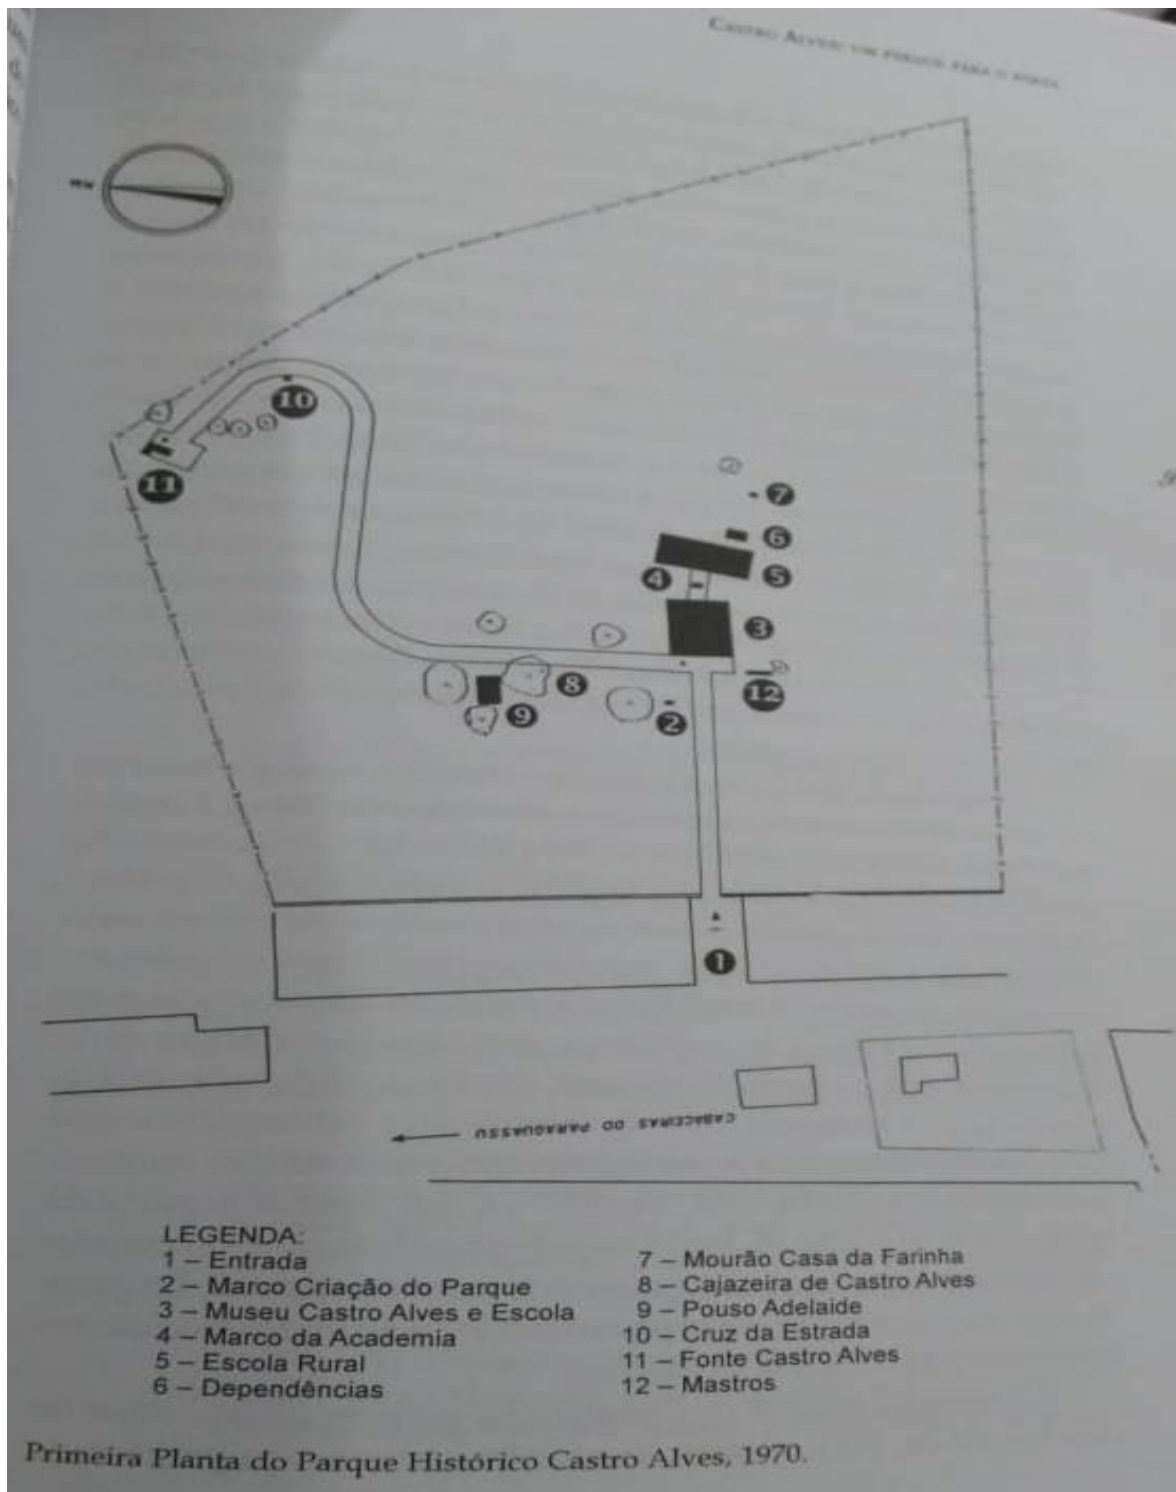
Primeira planta baixa do PHCA. Fonte: BOAVENTURA, 2006.
